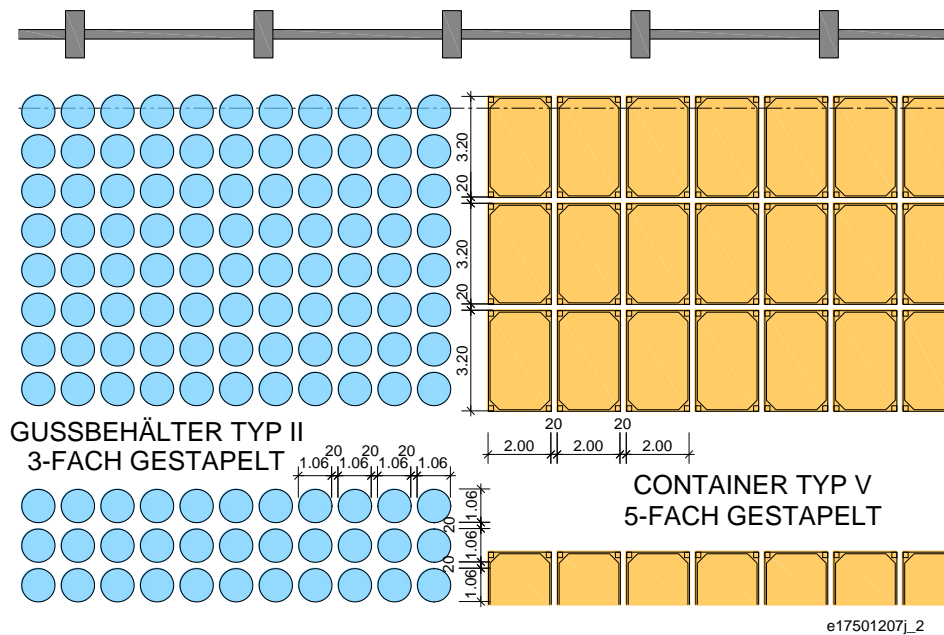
Aufstellung der Gebinde (Grundriss) in Halle 3
